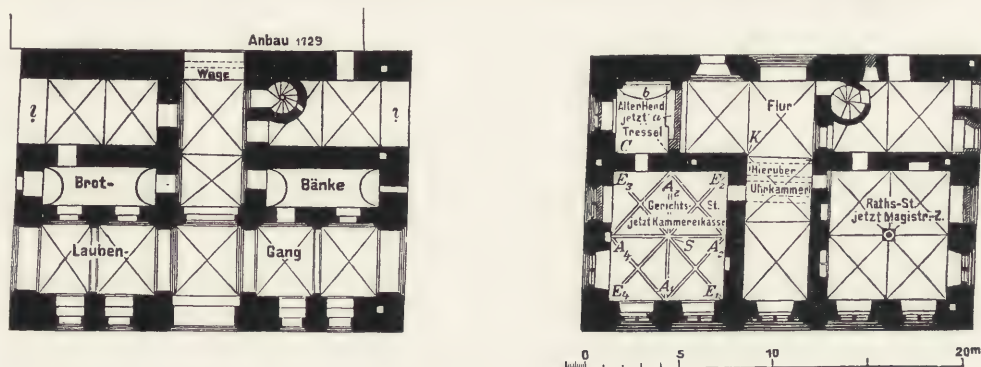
Rathaus zu Marienburg. Grundrisse vom Erdgeschoß und Obergeschoß. 1:400.
